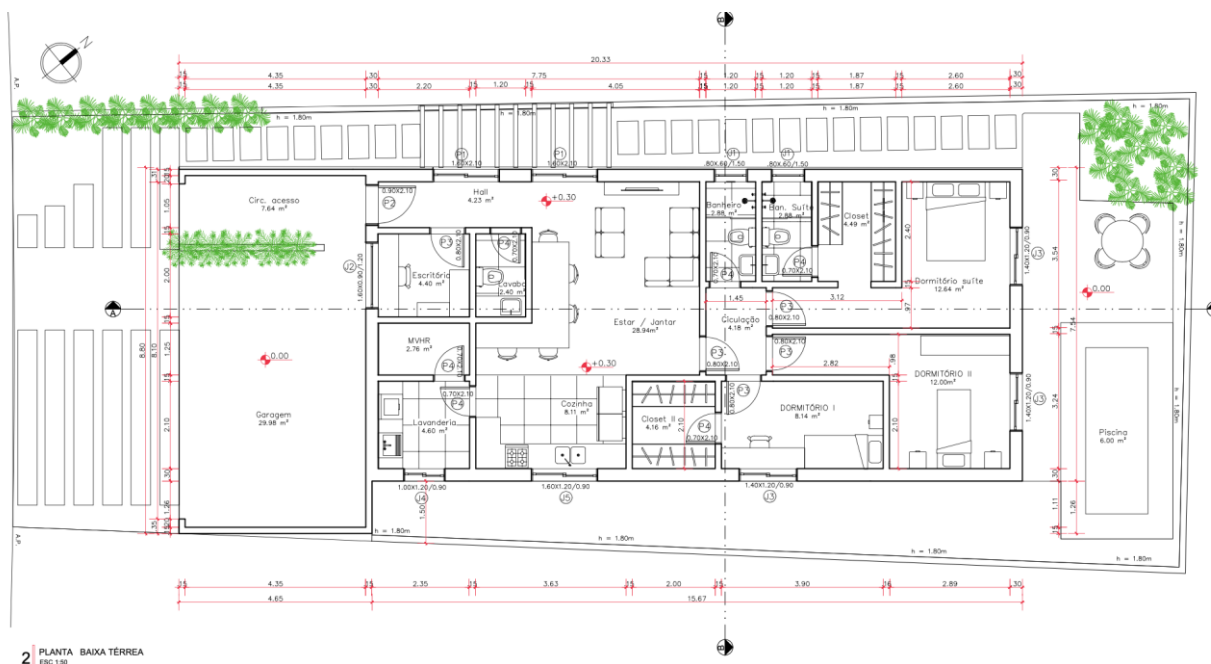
Planta baixa da edificação analisada, Pelotas, RS. Fonte: Autores.
